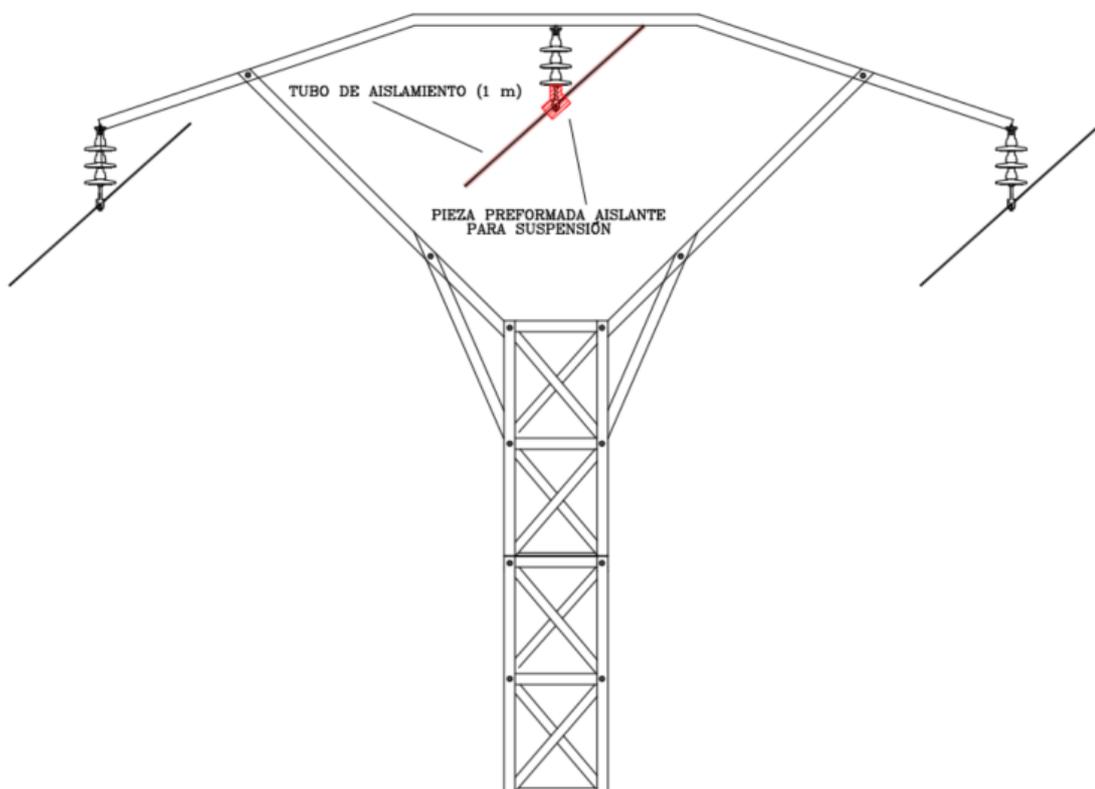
Apoyo tipo bóveda con cadenas de suspensión y aislamiento de la fase central
